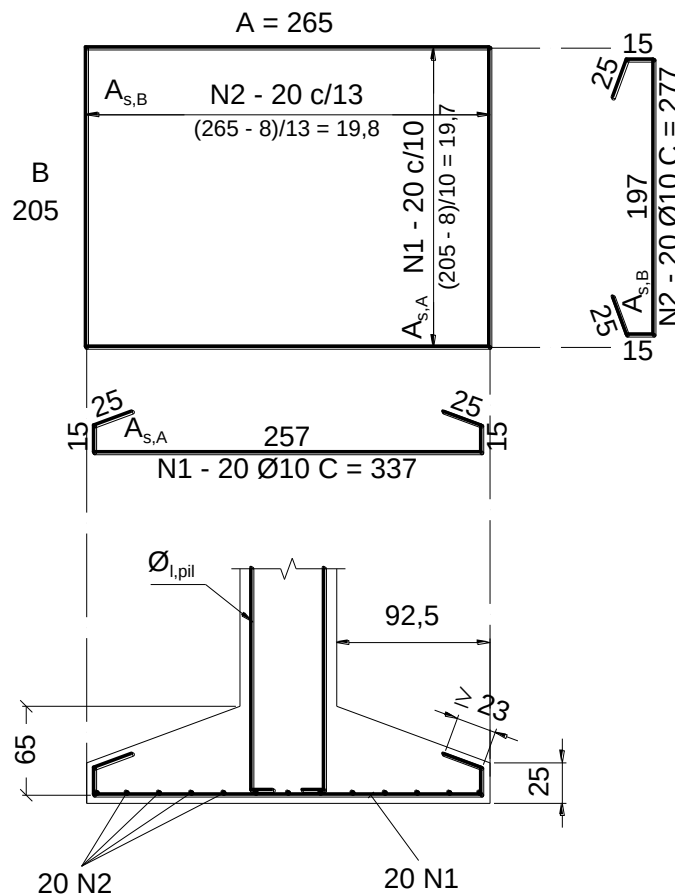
Detalhamento das armaduras de flexão da sapata.
